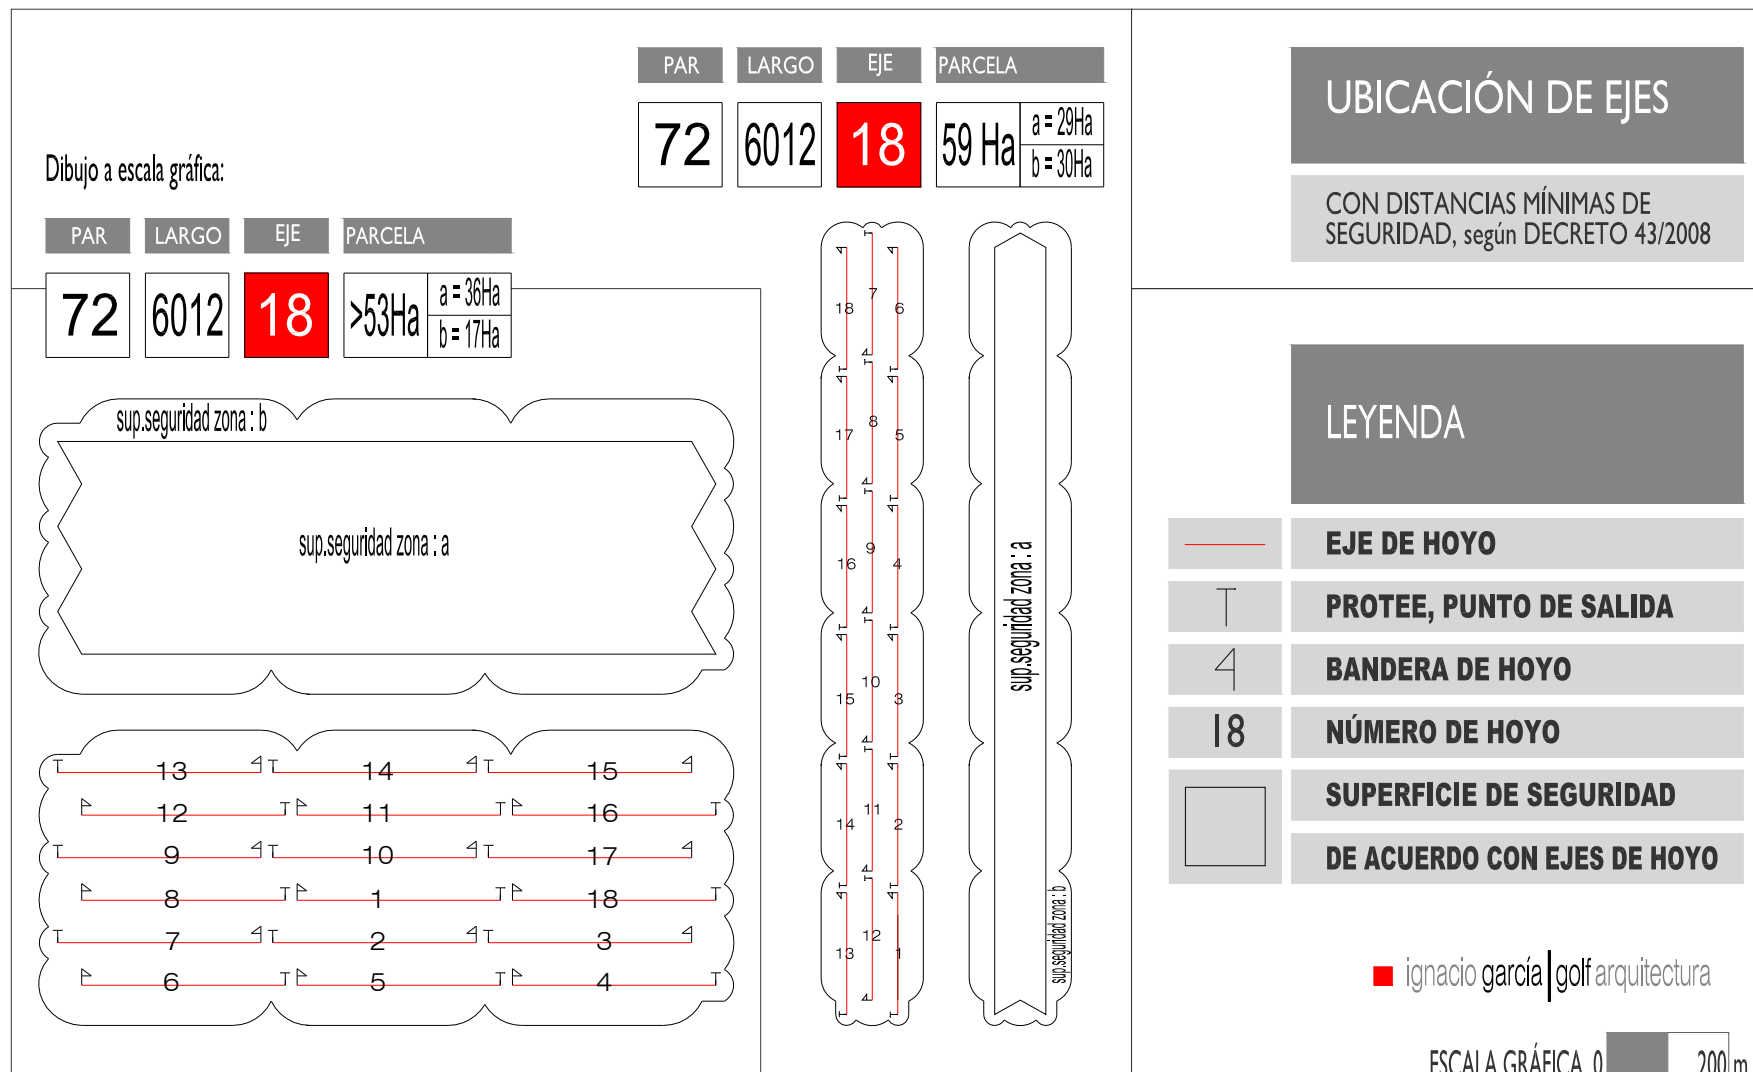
Ubicación de ejes en 3 y 6 columnas
